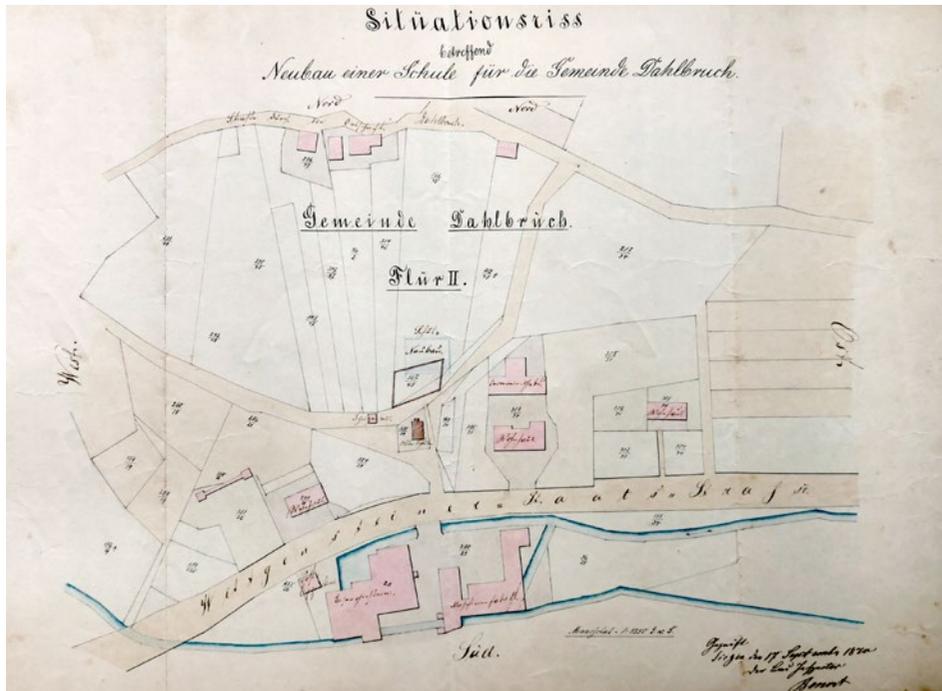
Lageplan Dahlbruch, 1870. Die blau markierte Fläche in der Mitte des Plans zeigt das Grundstück für den Schulneubau, südlich davon der Vorgängerbau. Ansatz zur Bildung eines Dorfmittelpunktes in Verbindung zur Eisengießerei.
